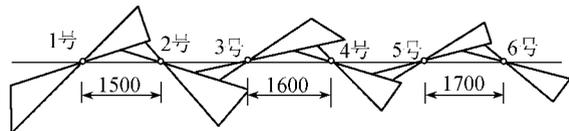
高喷防渗墙板墙试验孔布置示意图(单位:mm)
